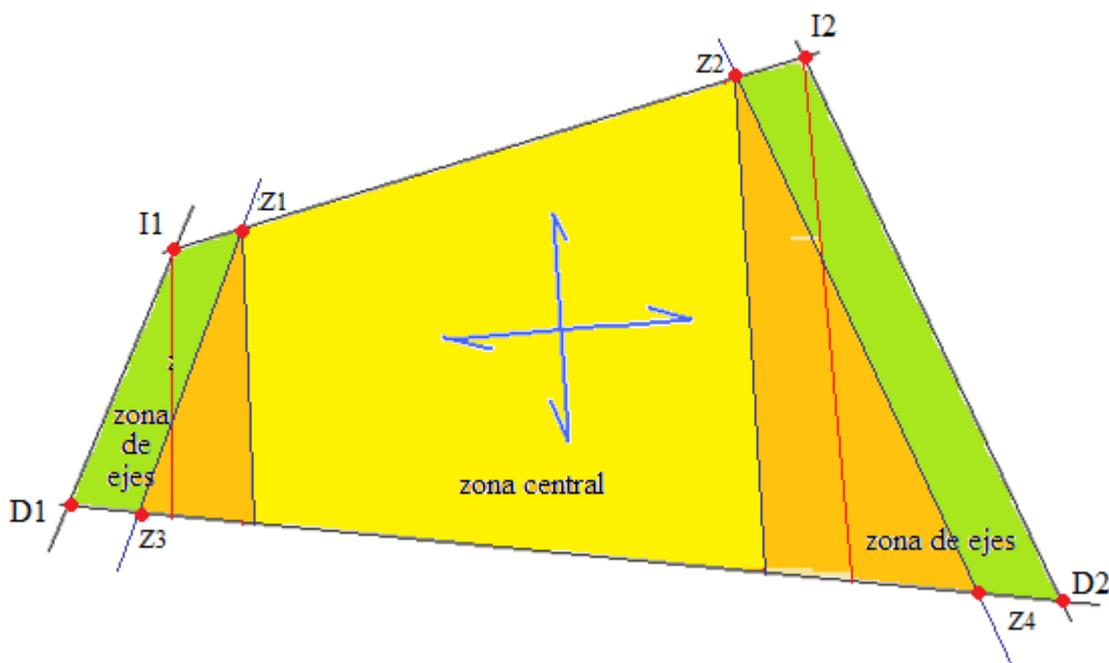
definición de las bandas de armado transversales. Zonas de zunchos.
